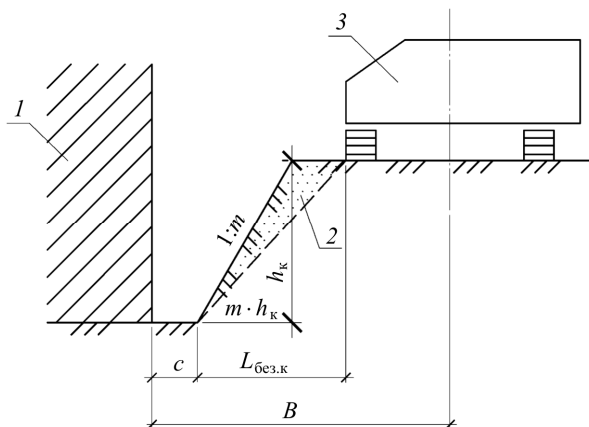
Схема поперечной привязки самоходного крана при возведении подземной части здания: 1 – строящееся здание; 2 – призма обрушения
